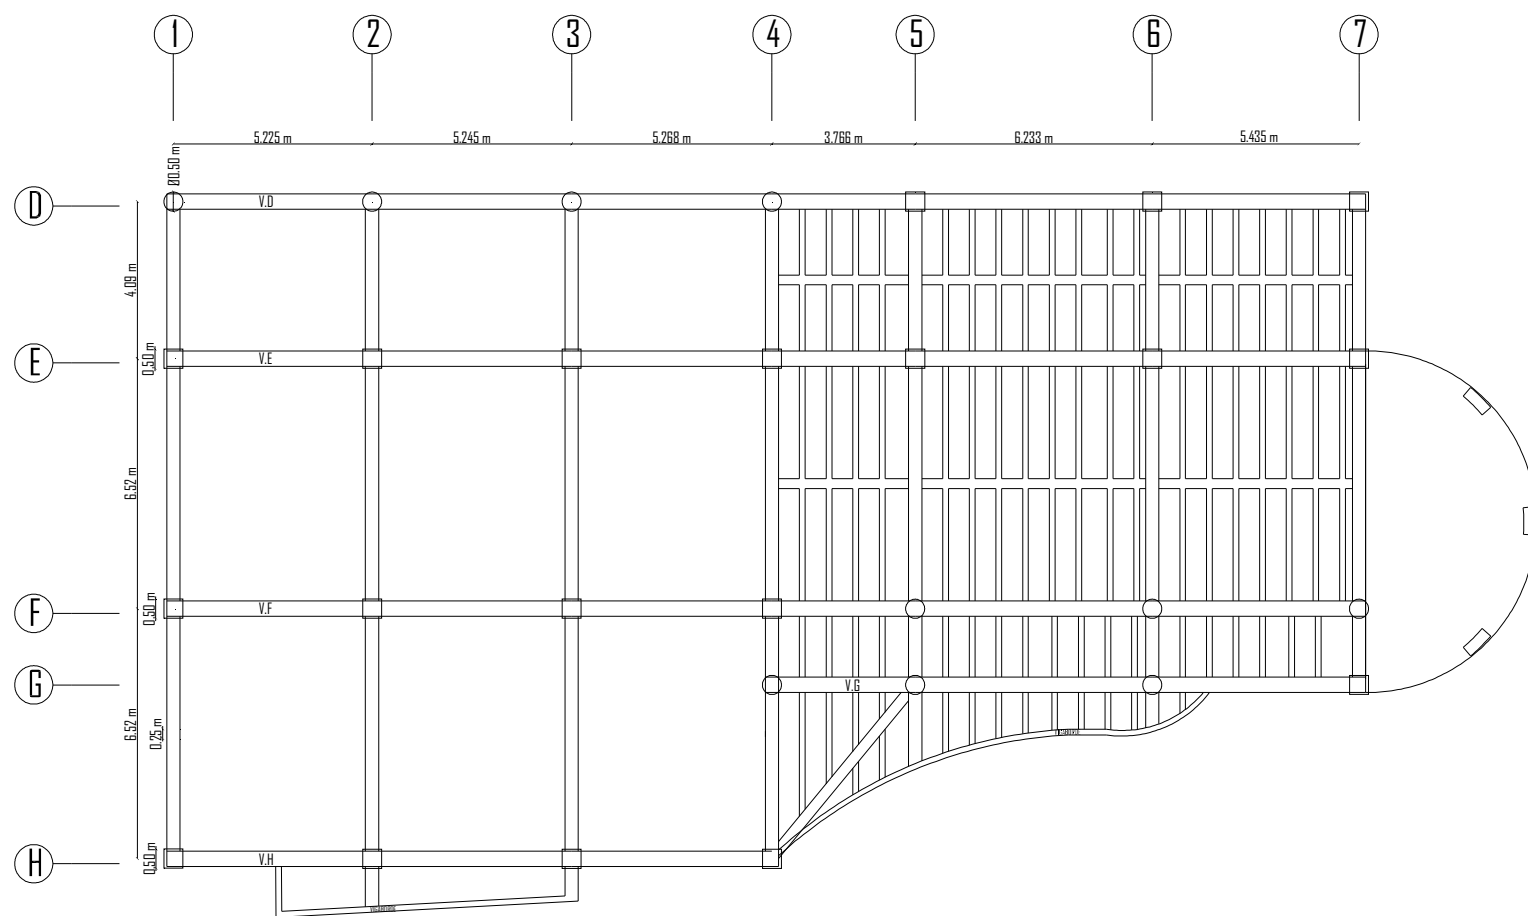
Secciones en planta de columnas, vigas, viguetas entre piso tres bloque uno
